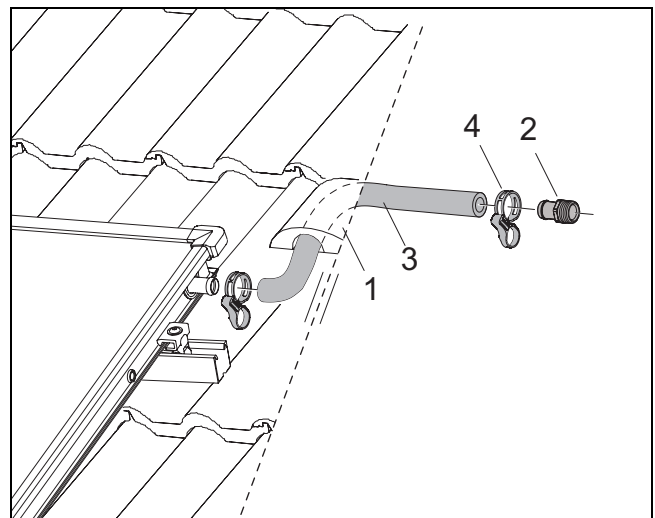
Монтаж трубопроводу для лінії подачі (без витяжки на даху)
